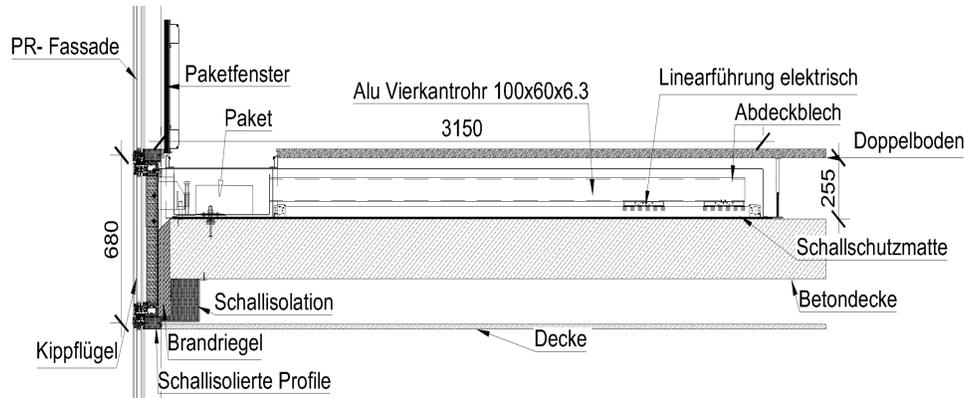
Vertikalschnitt Fassadenstation geschlossen
